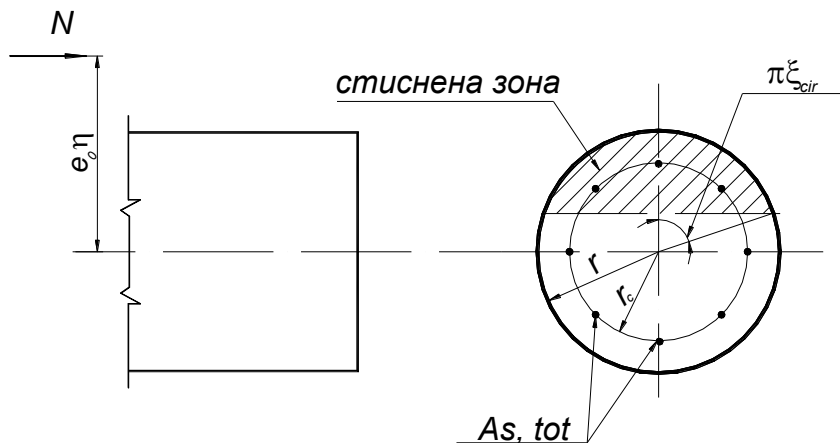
Схема, що приймається при розрахунку круглого перерізу позацентрово стисненого елемента
